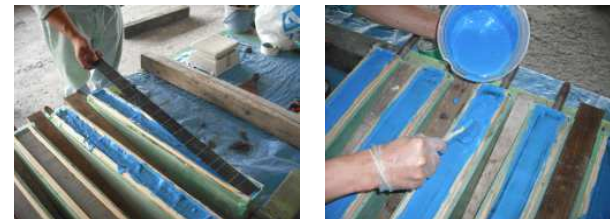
試験体作成状況およびひずみゲージ設置位置(JCM)
